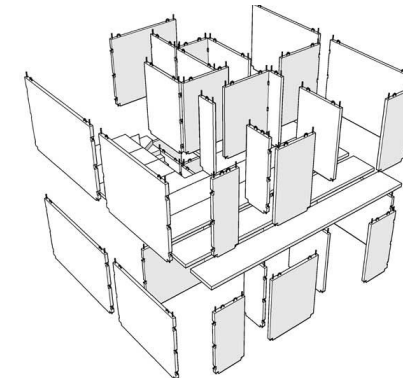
Ensamblaje de piezas prefabricadas por junta seca
